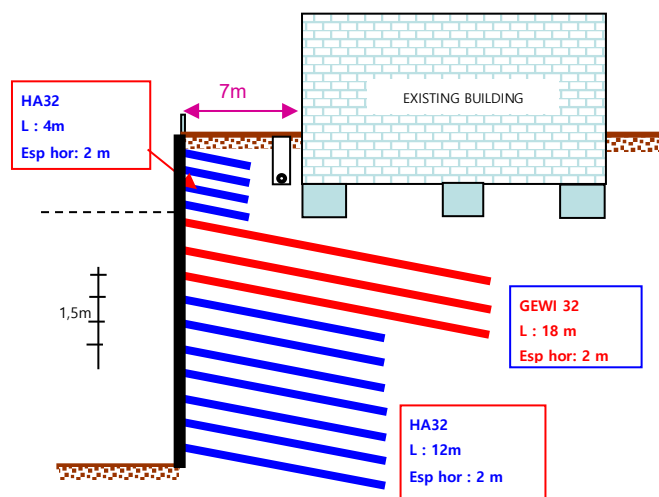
Coupe verticale de l'excavation sur le flanc gauche
